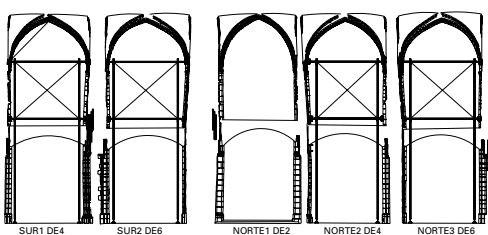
Alzado de los pórticos de atirantado de las bóvedas del crucero
